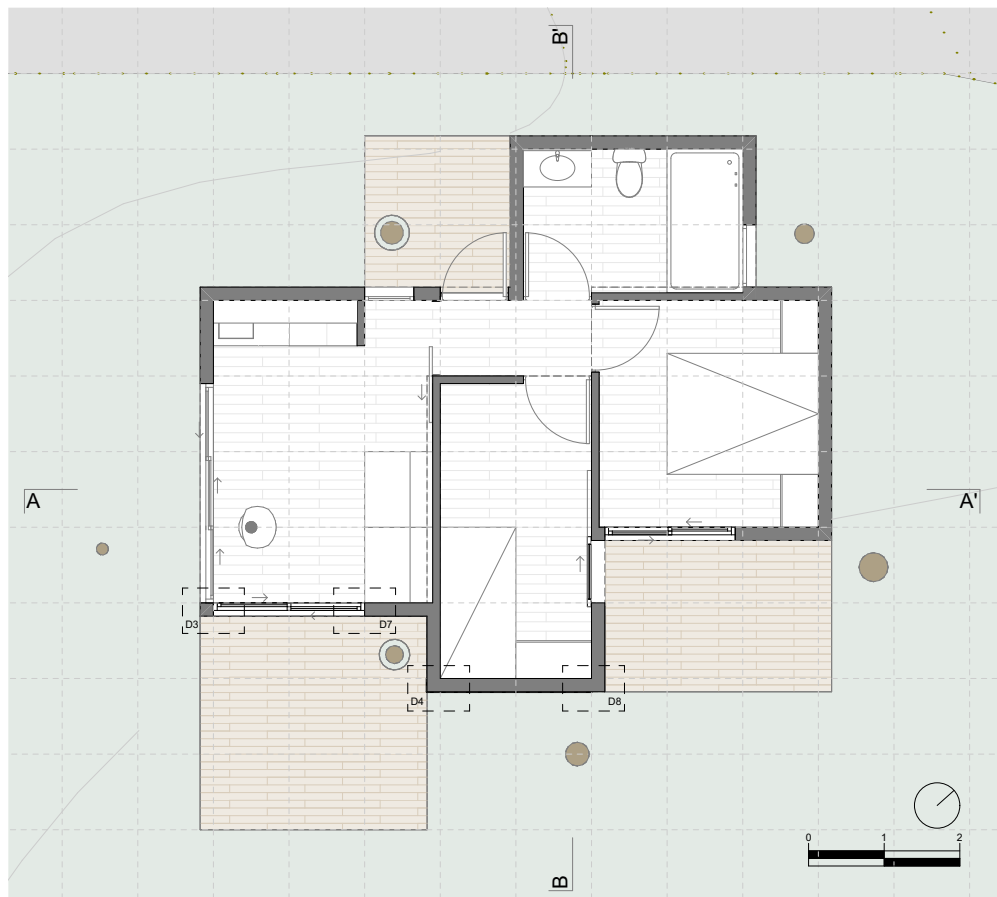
(Baixo) Planta de interiores da unidade habitacional, escala 1:100.
